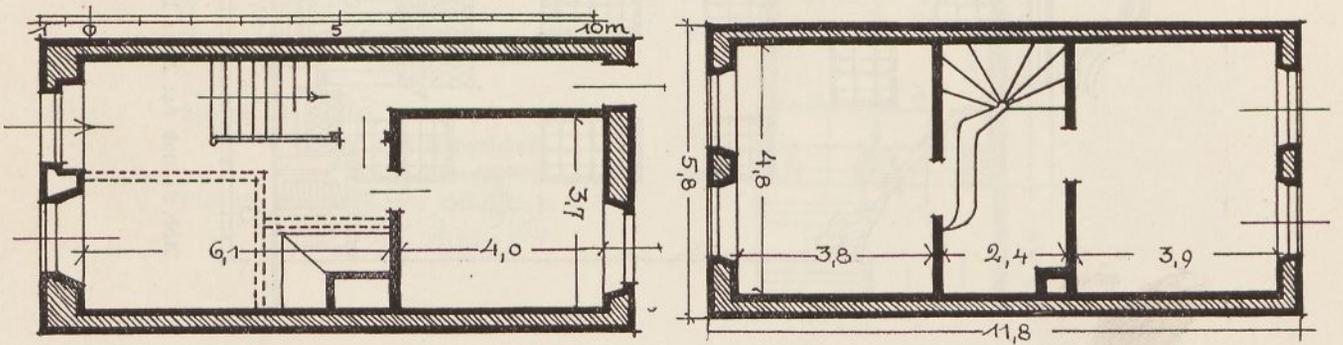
und 91: Wilhelmstr. 21, Grundrisse von Erd- und Obergeschoß
